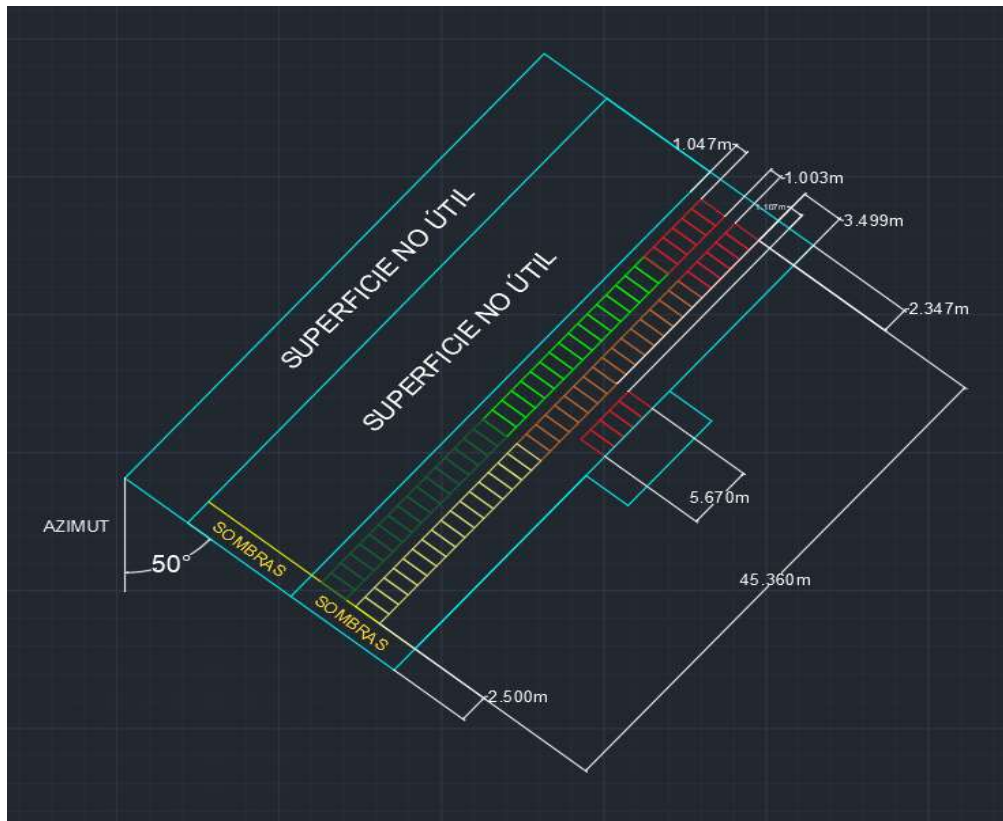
Planta de la cubierta. Disposición del array FV asociado a la propuesta de instalación 1, junto con las cotas asociadas.
